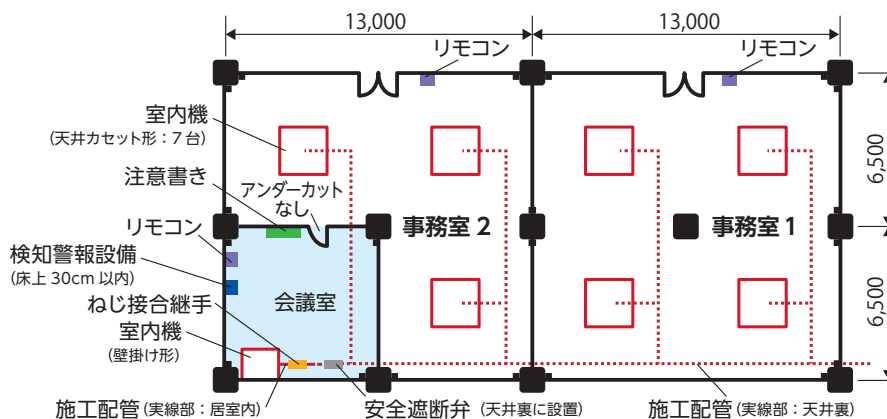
設計例（一般オフィス）「施設側」の安全対策平面図
